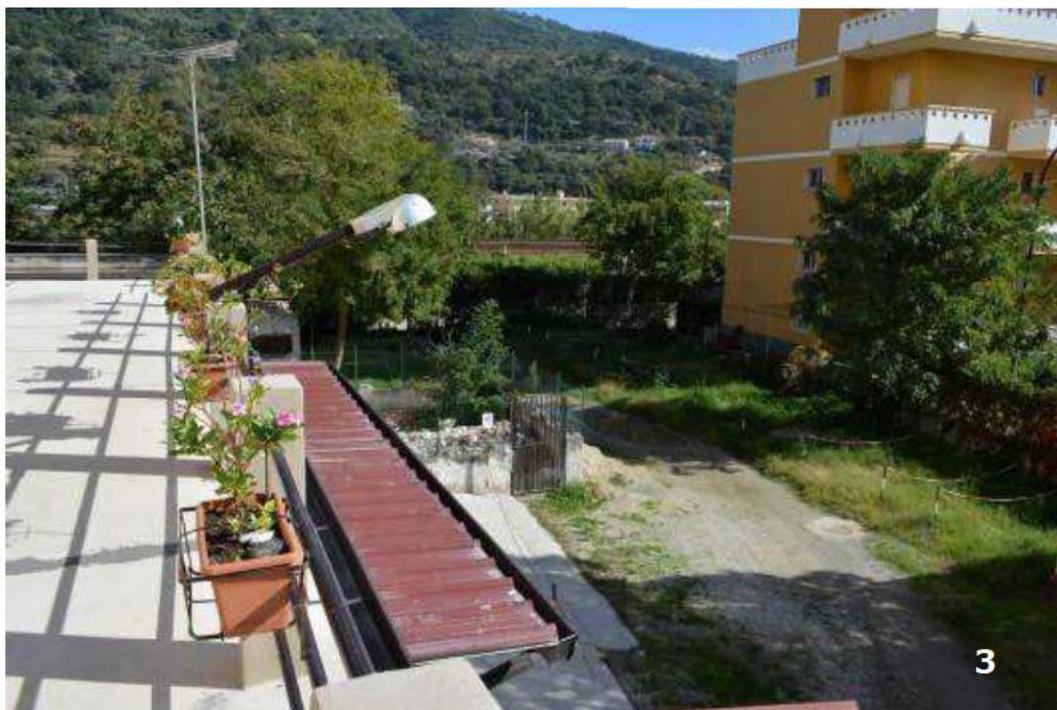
e 4: bene immobile n. 1; vista dall'alto verso la strada di accesso, strada privata antistante l'immobile.
